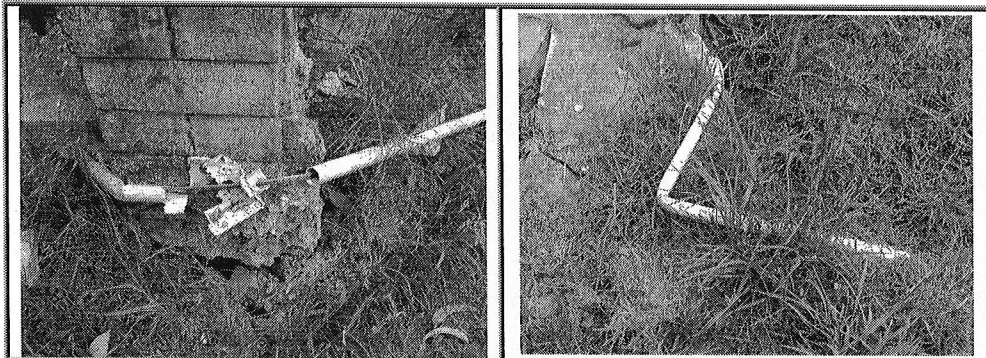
Evidencia de la ruptura y alto grado de tensión en los conductos y cables que forman parte de la red de energía eléctrica perimetral en el Conjunto Residencial Lipari.
